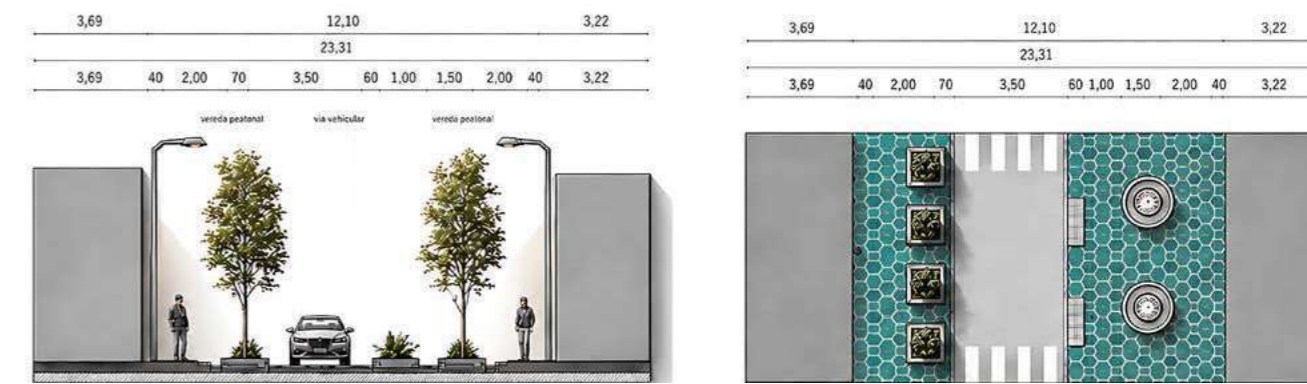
Sección y planta propuesta en la calle Tomás Ordóñez. Elaboración propia.
